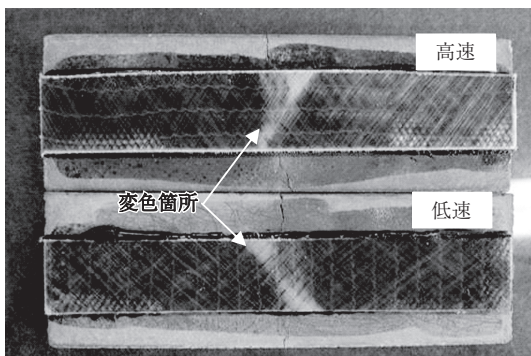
変色状況の例 (No.5, ひび割れ幅: 0.5 mm)
